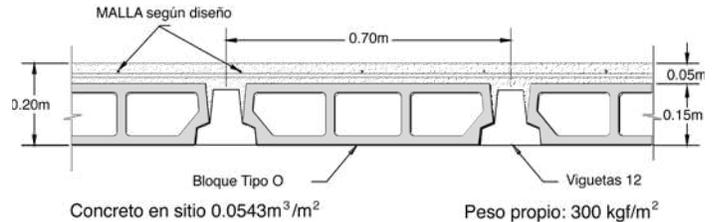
Detalle típico de entrepisos de vigueta de 12 cm con bloque tipo O
